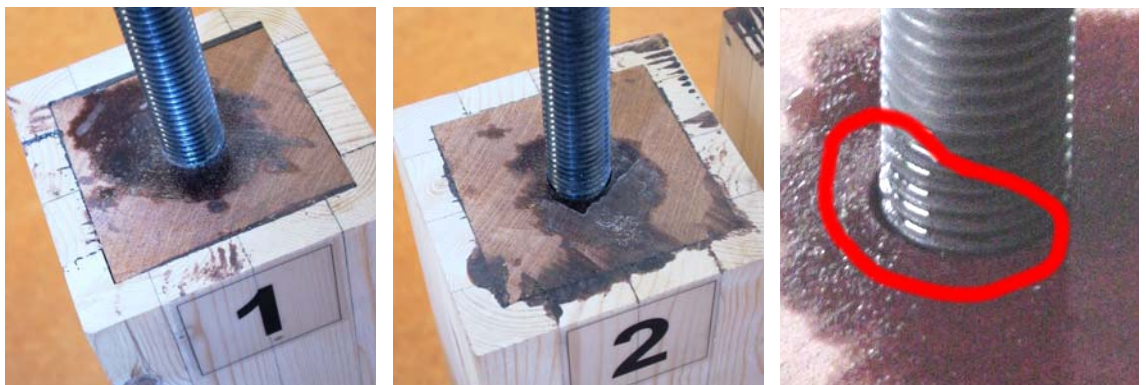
Detalle del encolado entre perno metálico y macizo de madera. Adhesivo Sikadur 52. Inyección.
